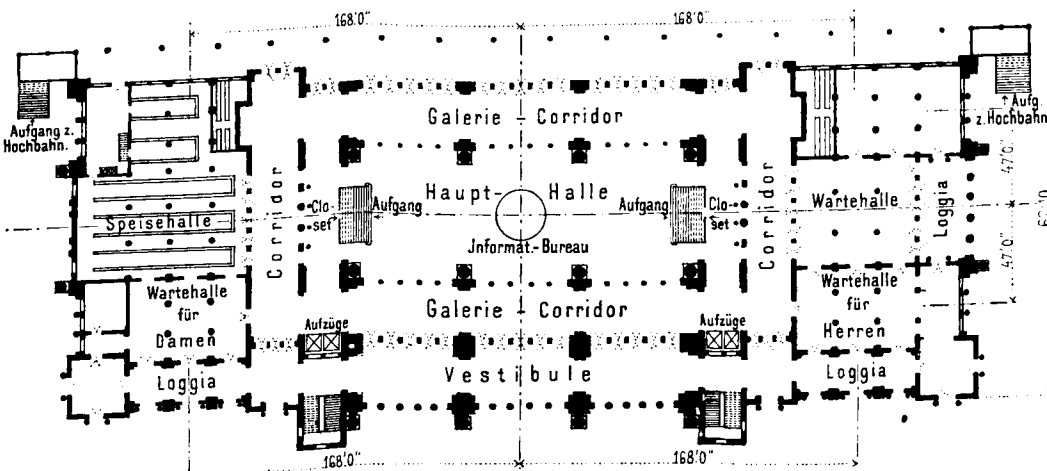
Grundriss des Bahnhof-Gebäudes 1:125.
